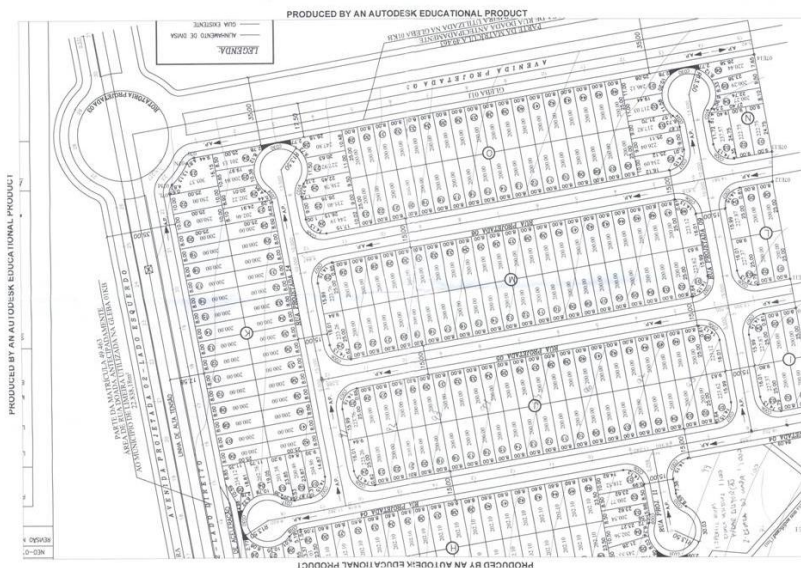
Loteamento proposto para o levantamento do perfil longitudinal das vias
